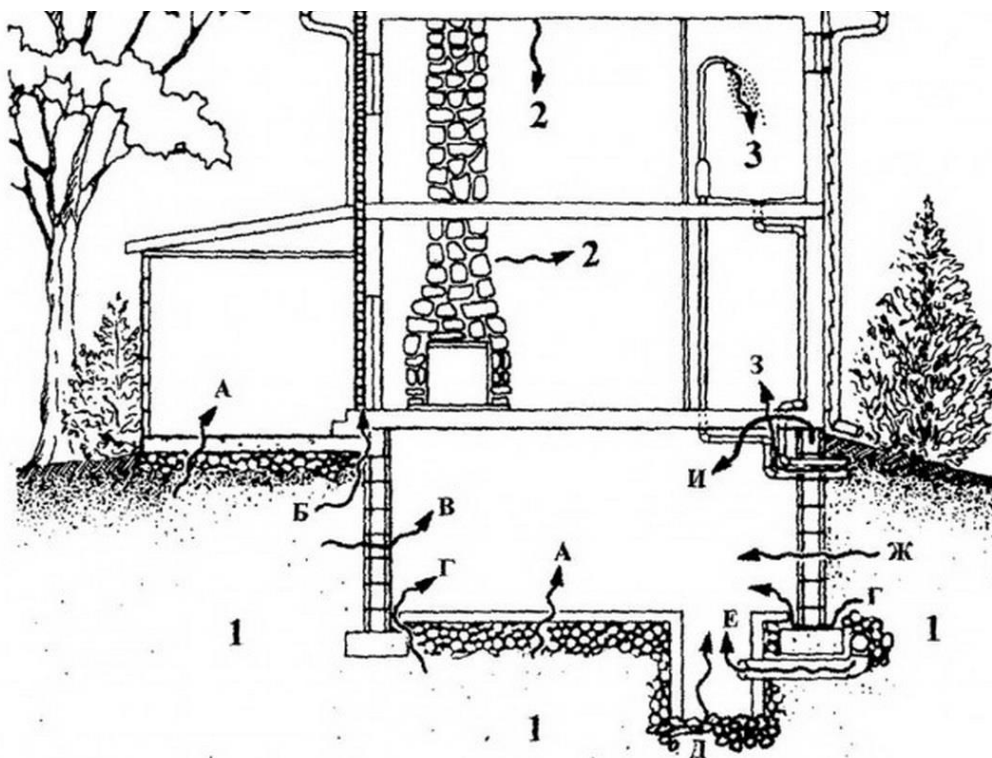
Основные источники (1-3) и пути проникновения (А-3) радона в здания. 1- почва под зданием, 2- строительные материалы, 3- вода из подземных источников; А- трещины в бетонных перекрытиях, Б- пространство за облицовочной стеной, установленной на не перекрытом фундаменте из полых блоков, В- поры и трещины в бетонных блоках фундамента, Г- соединения между полом и стенами, Д- открытая почва (например, дренажном колодце), Е- швы между блоками фундамента, заполненные раствором, Ж- плохо изолированные вводы труб и коммуникаций, 3- открытые торцы пустотелых блочных стен.
